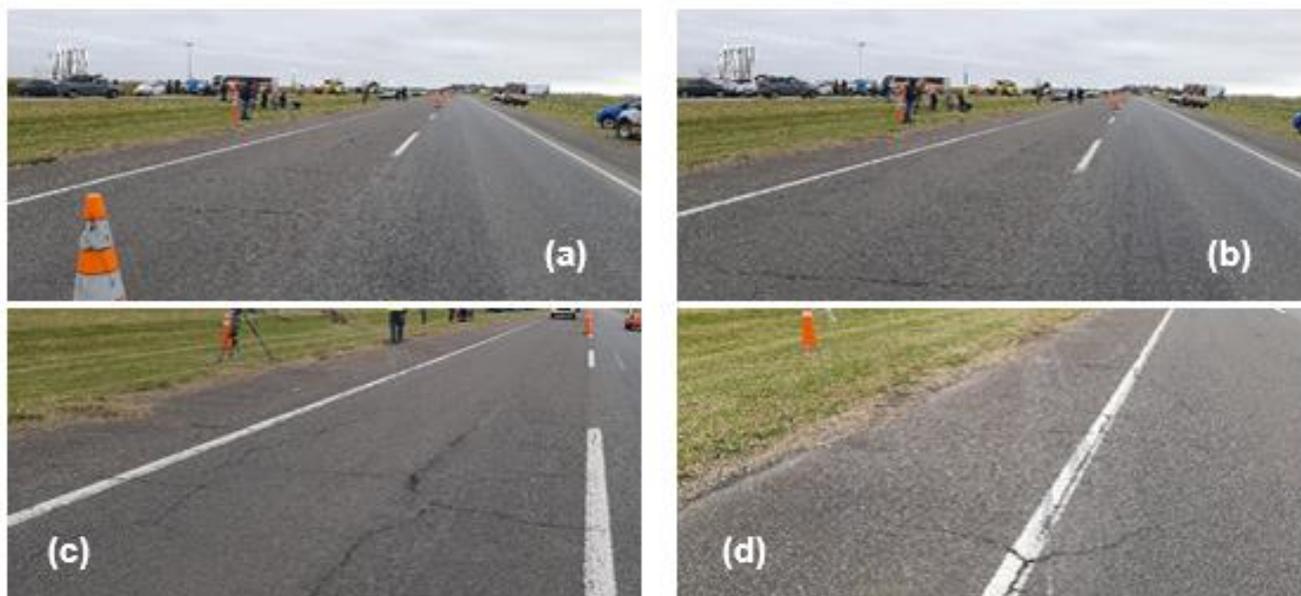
Imágenes representativas de las principales fallas observadas en la calzada. (a) fisura longitudinal y transversal en calzada carril izquierdo sentido CABA (b) carril deprimido con fisuras. (c) carril izquierdo con fisuras longitudinales y transversales formando cuadrículas. (d) fisuras entre borde de calzada y banquina (Fuente: JST).
